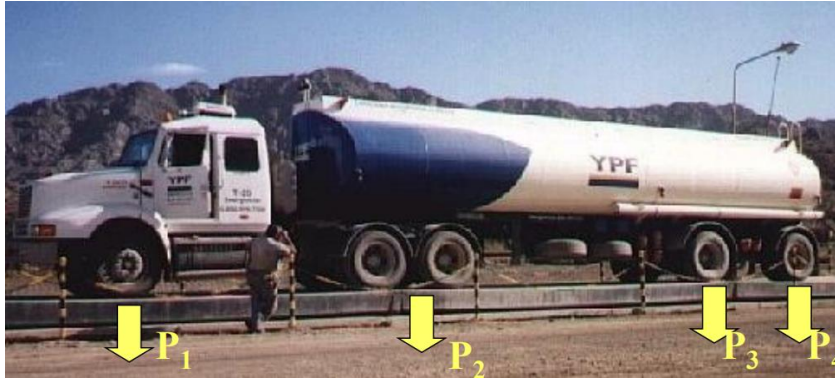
Cargas transmitidas por un camión al pavimento. Fuente: Ingeniería de Pavimentos. Sánchez Sabogal, Fernando (2006).
